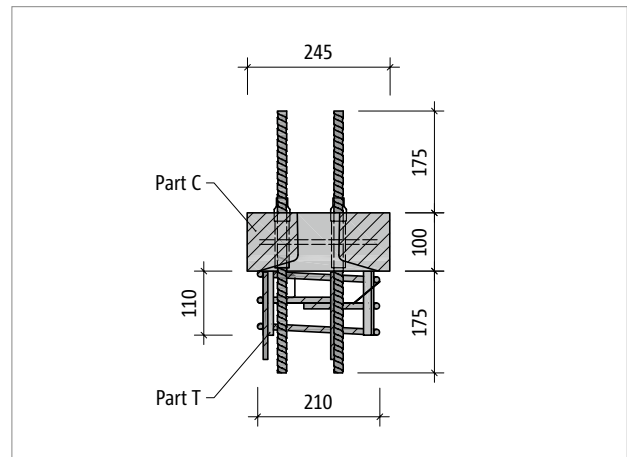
Schöck Sconnex® type P-B250: Aanzicht van bovenaf
